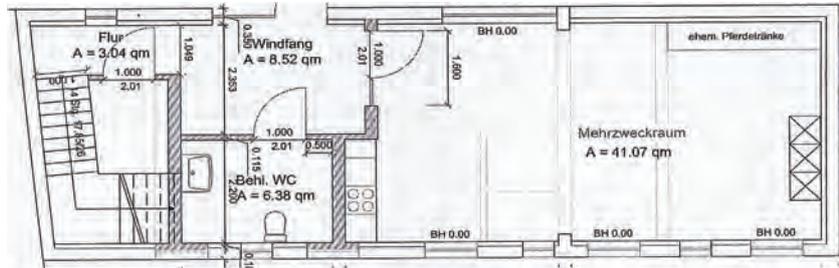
Grundriss „Ausspanne Rieth am See m.H.“
